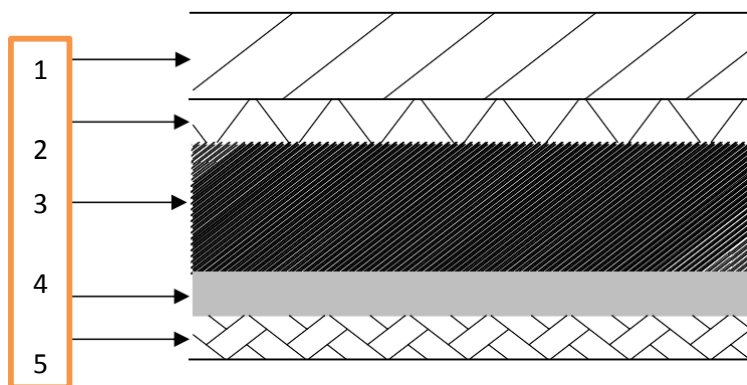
a.3 : Coupe transversale du plancher dalle pleine.
